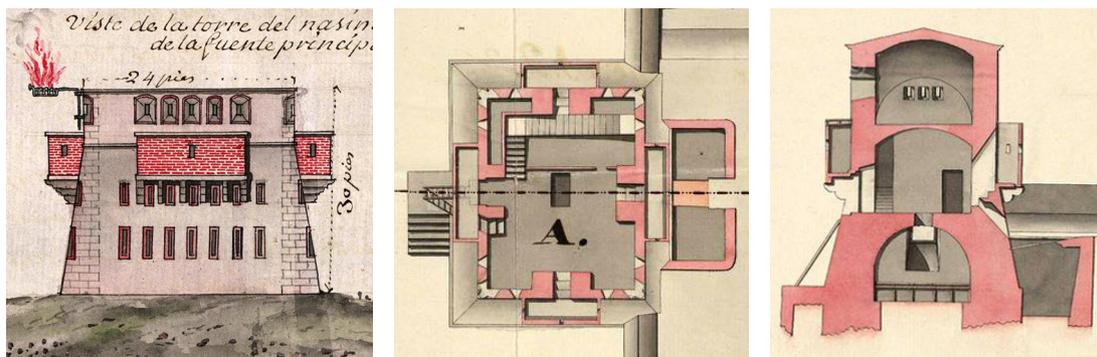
Proyectos de torre aislada en Orán. A la izquierda, vista lateral de la torre del nacimiento de la fuente principal, detalle del “Plano de una porción de las huertas contenidas desde el origen de la fuente hasta el puente de Tremecén”, Orán, 1743. En el centro y a la derecha, sección en planta y sección lateral de la misma torre, detalle del “Plano y perfil de la torre del Nacimiento con el de la batería provisional que se ha proyectado y dado principio a construir con comunicación con la expresada torre”, Orán, 1773. Fuente: Catálogo de Mapas, Planos y Dibujos del Archivo General de Simancas, AGS MPD 11-098 (izquierda) y AGS MPD 04-112 (centro y derecha).
